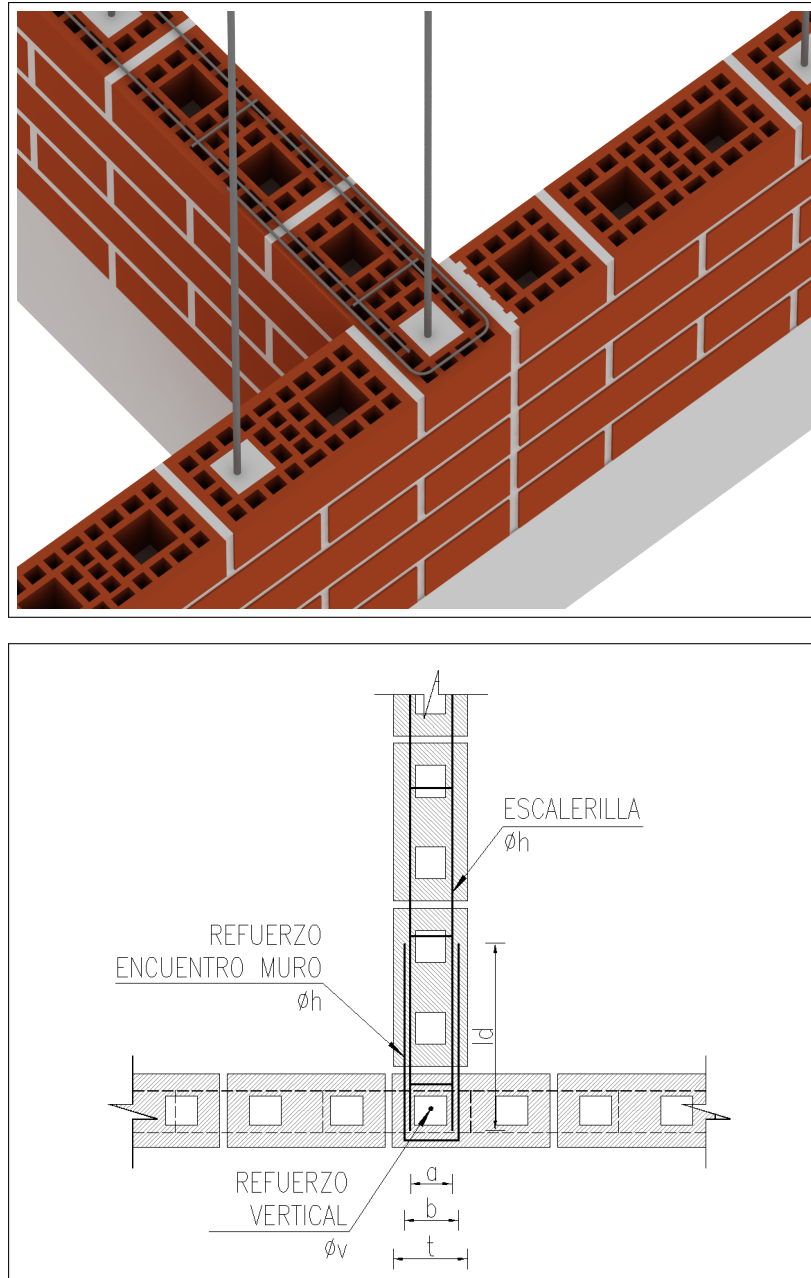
Detalle del anclaje del refuerzo horizontal (escalerilla) en un encuentro de muros en T .
